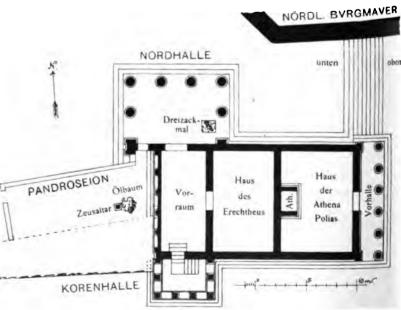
(64). Grundriss des Erechtheion.
